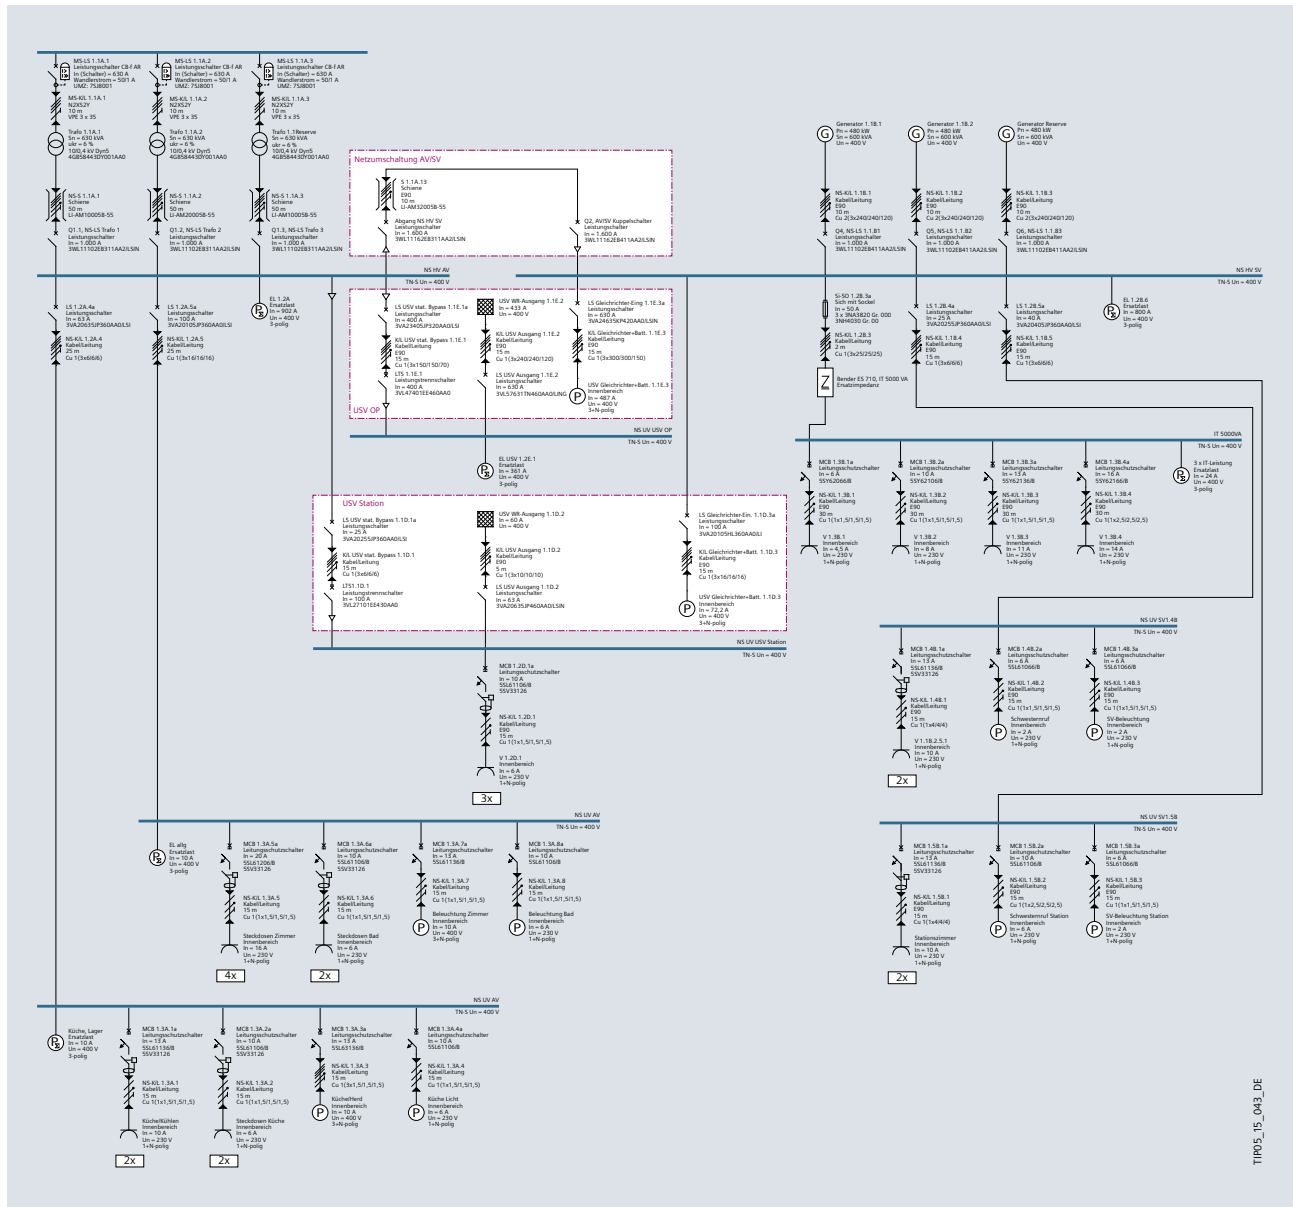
/7: Nachbildung einer Bettenstation in SIMARIS design
